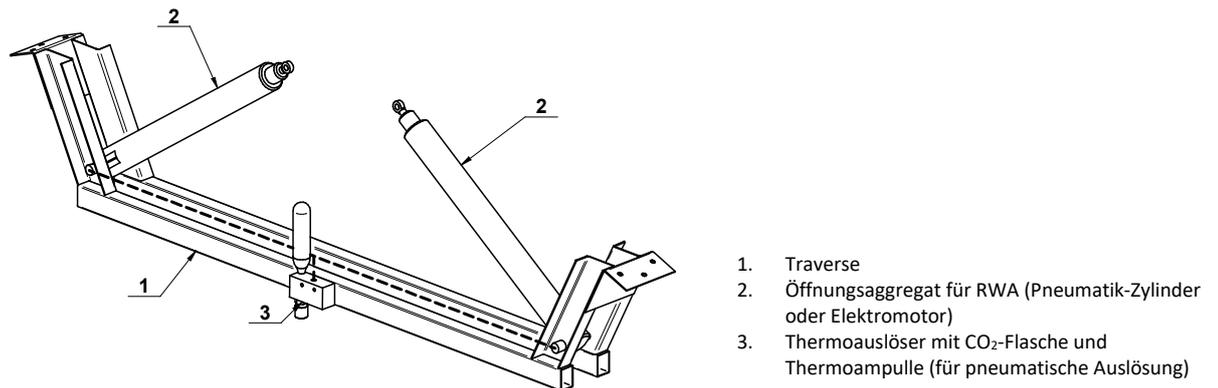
Öffnungssystem vorbereitet für die Installation (komplett montiert)
